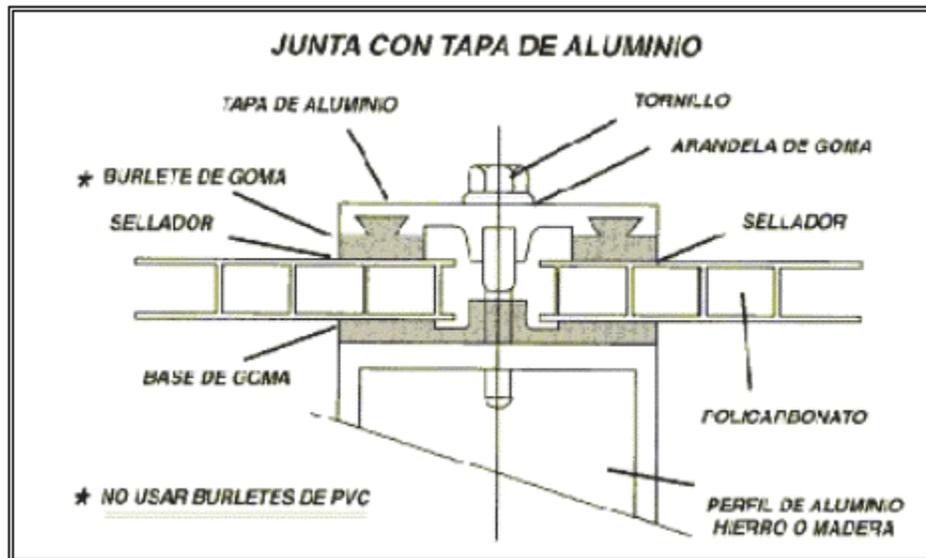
Detalle de corte de un perfil de aluminio.
